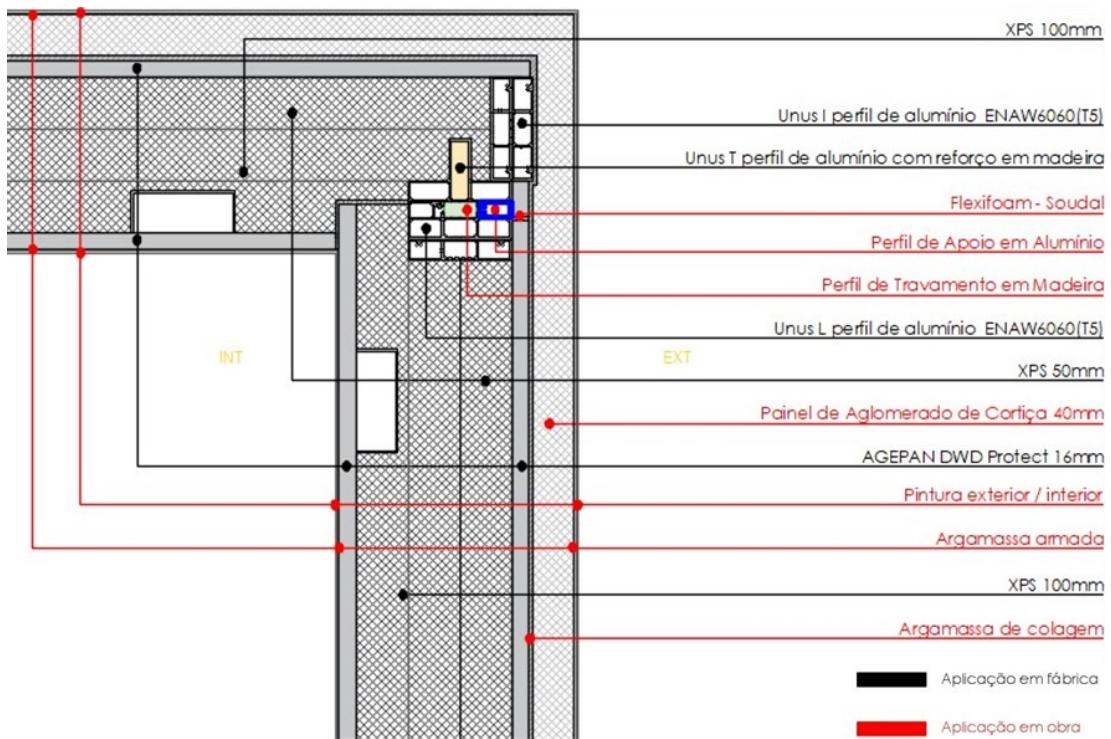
Solução Final – Pormenor construtivo de canto de paredes verticais.
